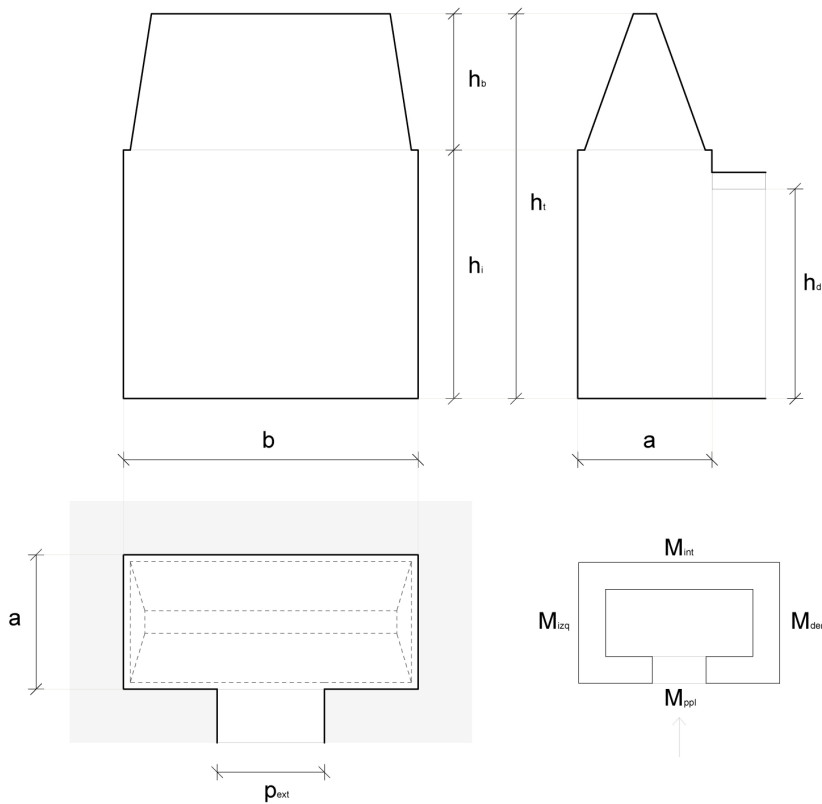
Medidas principales de la bóveda en planta, sección longitudinal y sección transversal.
